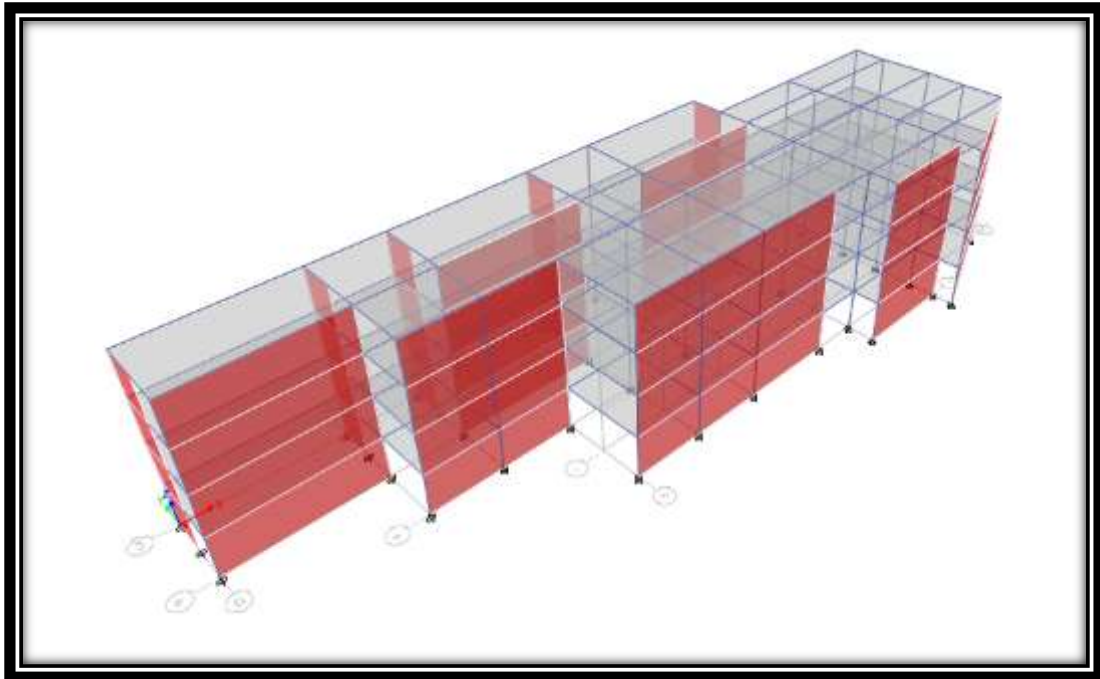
, Vista de la estructura original en planta por Etabs en 3d.
